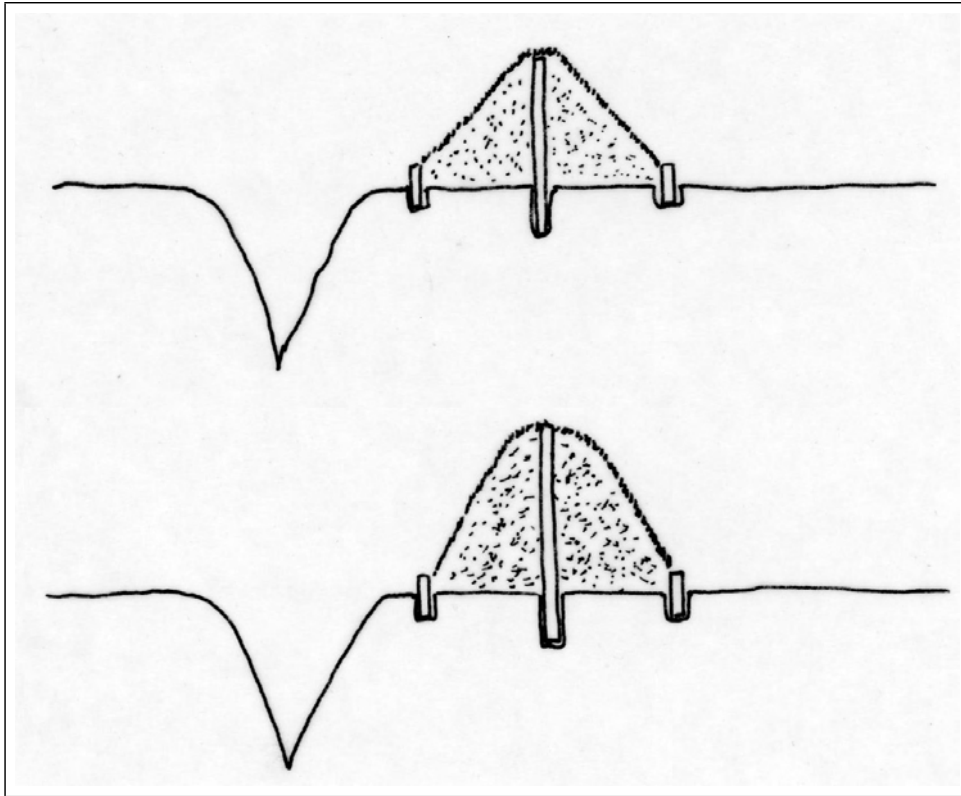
Wallformen gemäss der Befundlage einer dreifachen Palisadenreihe. Oben mit 45°- und unten mit 60°-Winkel.
